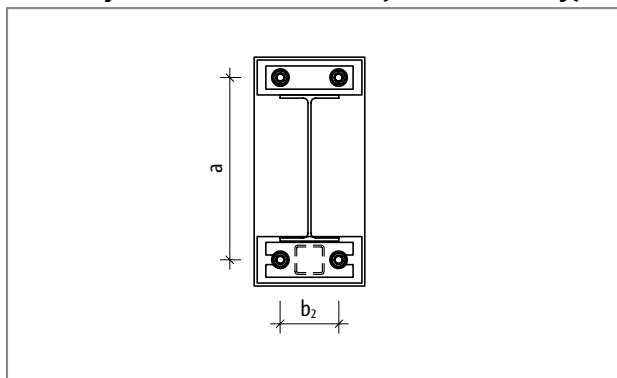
Čelní kotevní deska T typ S: rozměry dle následující tabulky; řez
